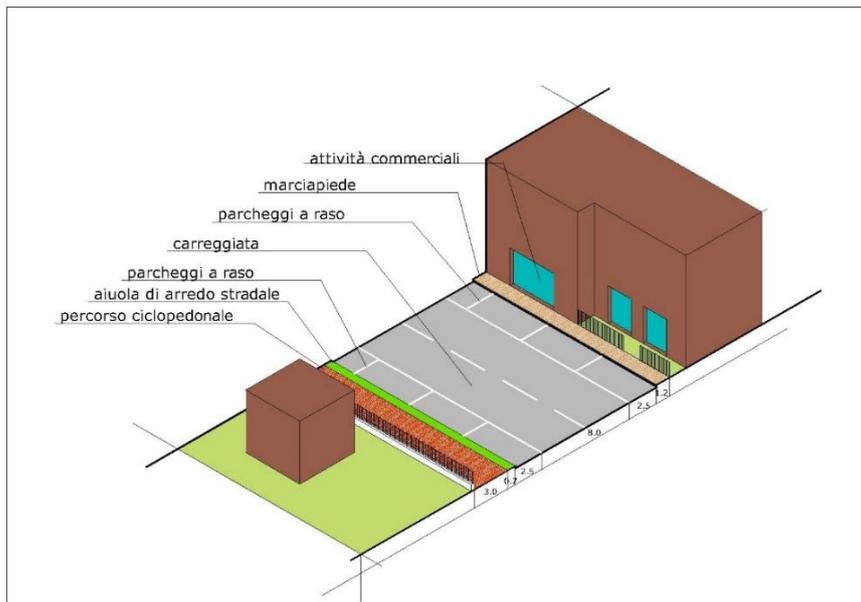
Rappresentazione schematica stato di fatto sezione 1
